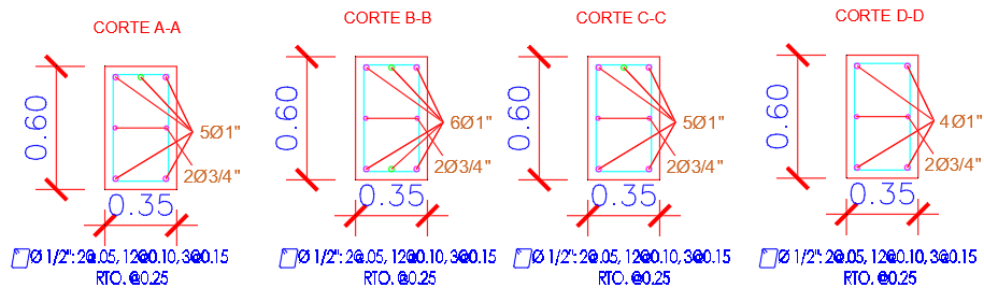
Secciones de Viga con Refuerzo 6° Piso
